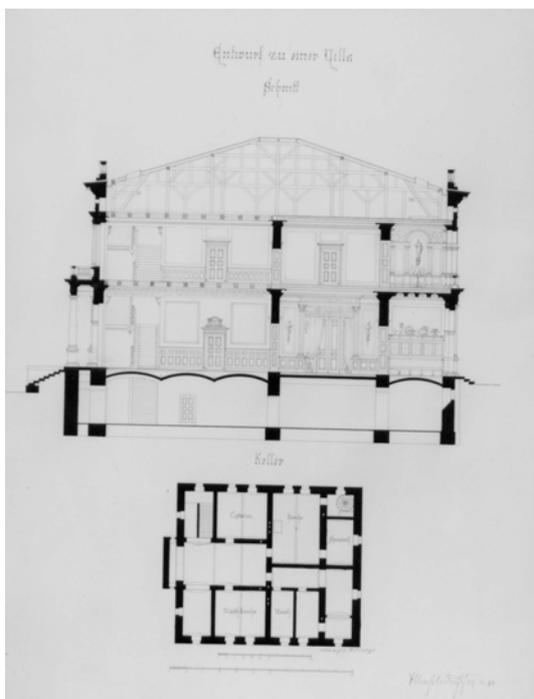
Heinrich Plange, Entwurf zu einer Villa, Schnitt und Grundriss Kellergeschoss, 1879
